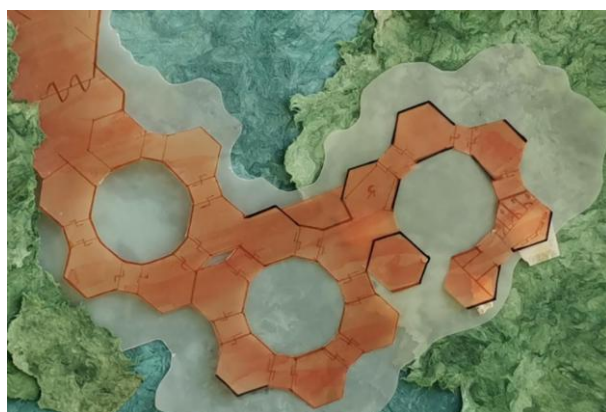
Planta arquitectónica indefinida en entrega final
